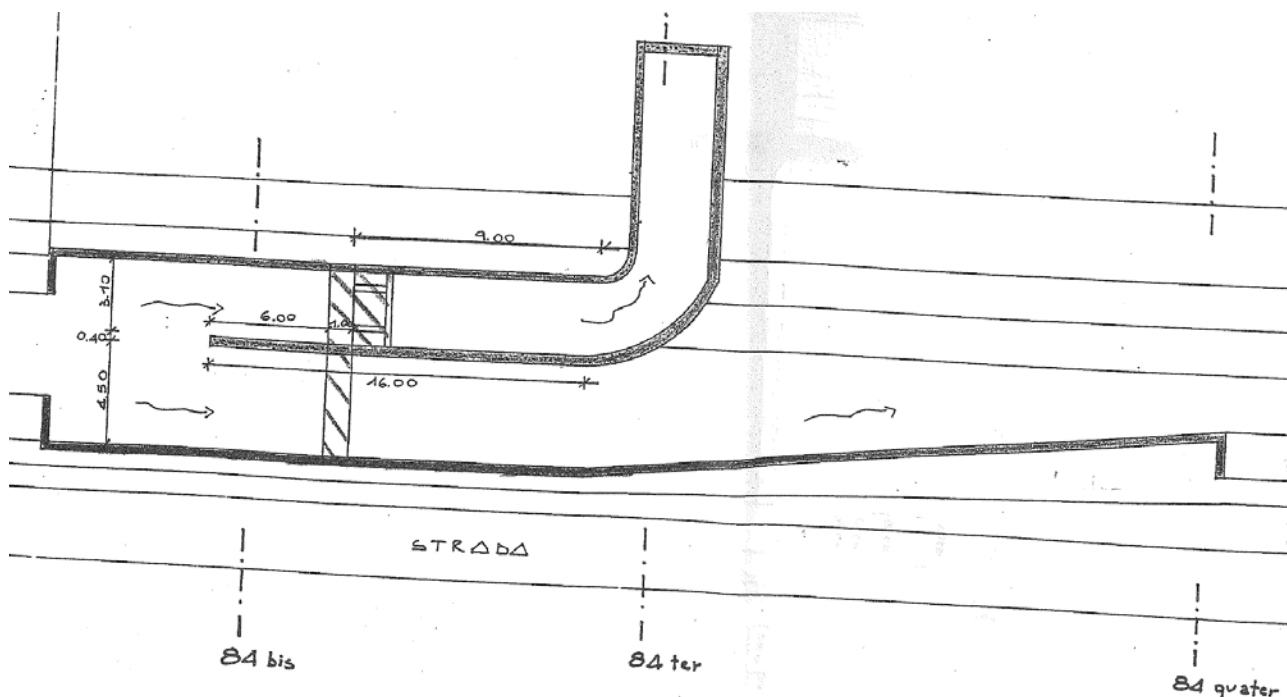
Estratto planimetrico progetto costitutivo dell'opera di presa.
